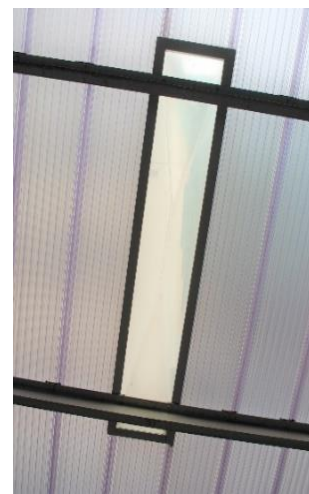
Imagen de detalle de salientes en fachada (exterior e interior)
